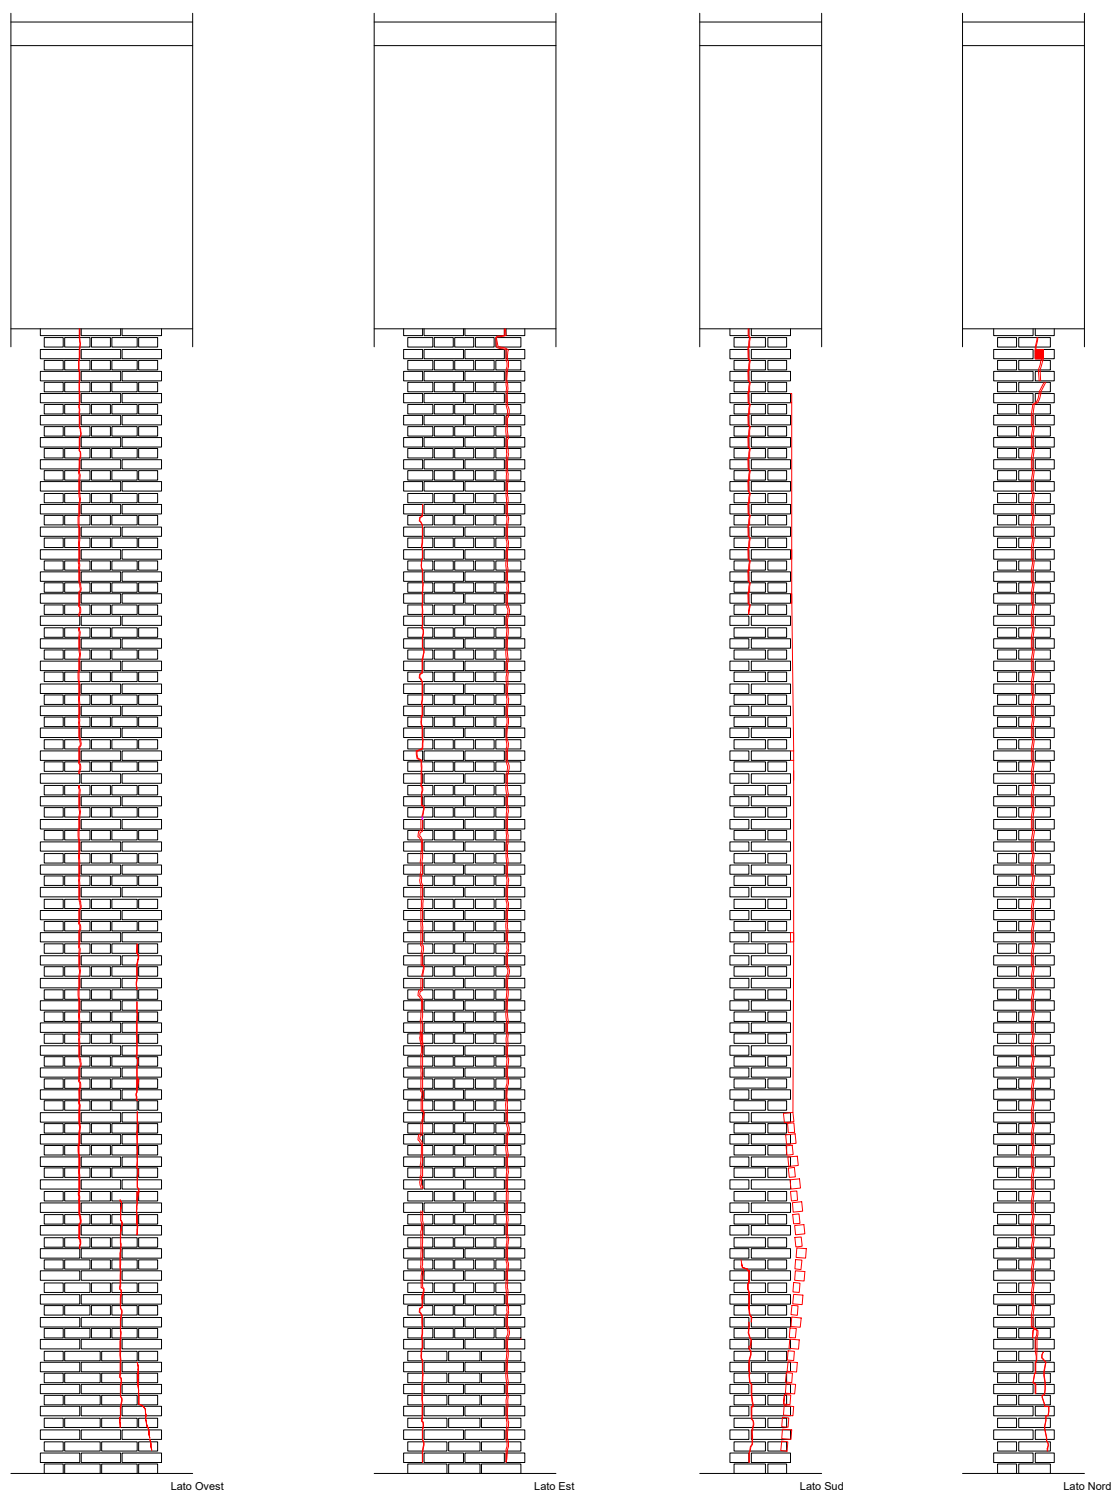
Rilievo del degrado di uno dei pilastri rivestiti. C. Mura, M. Pisanu.
